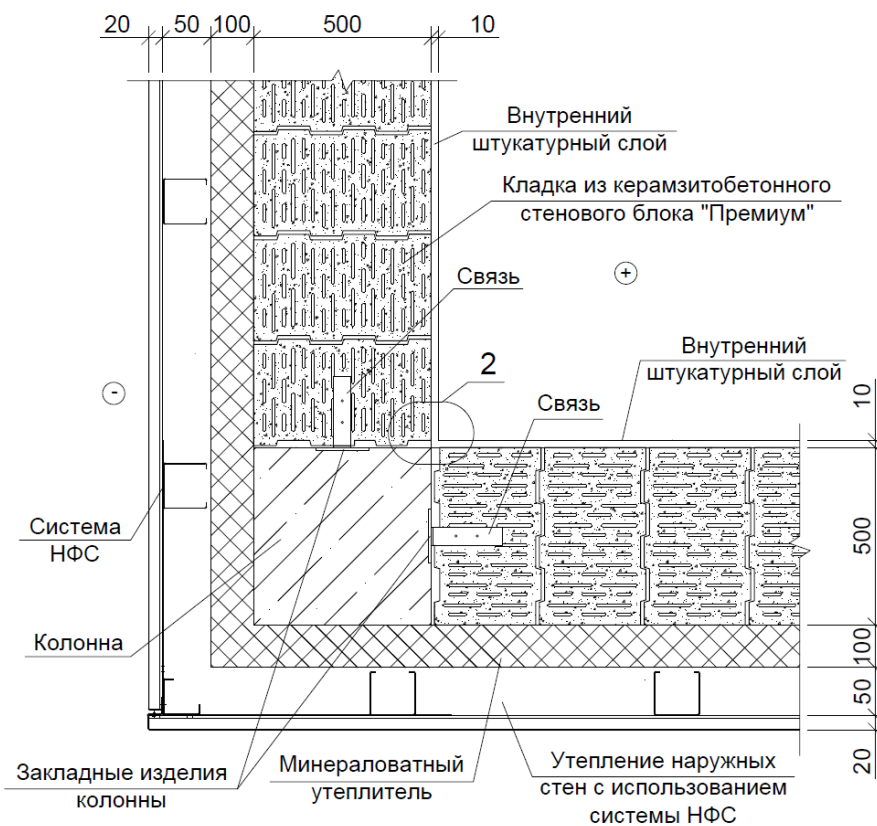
Узел крепления наружной стены к монолитной колонне.
